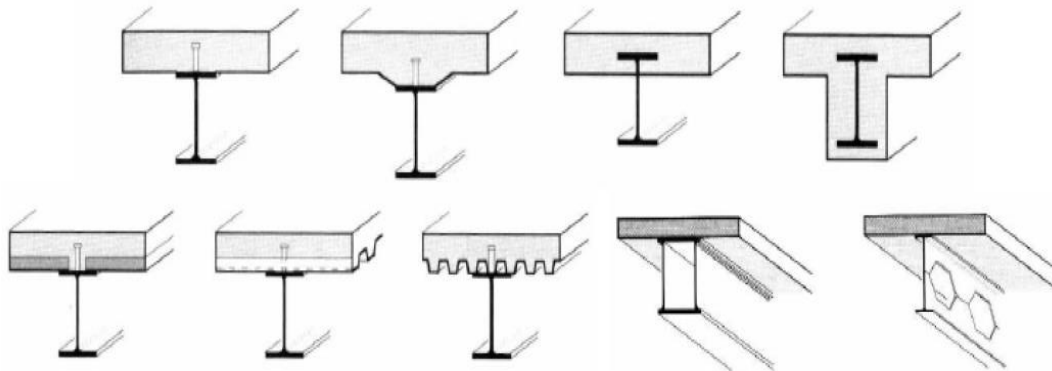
Exemplos de Vigas Mistas (FERRAZ, 2009)
